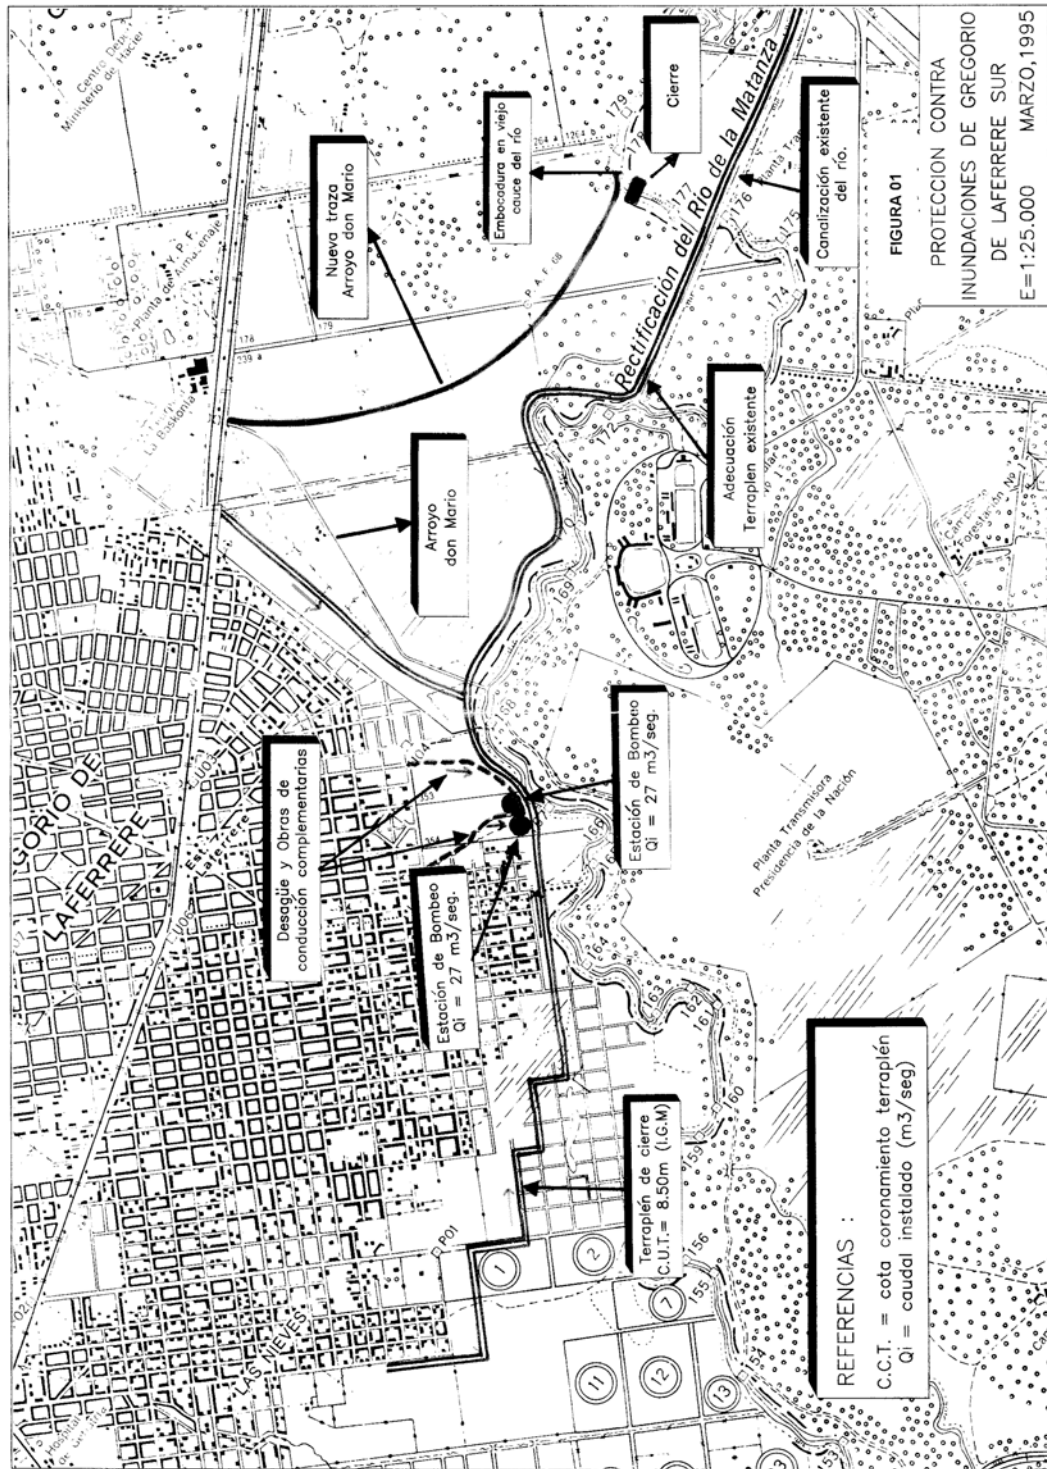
Protección contra inundaciones en la zona de Laferrere previsto según el Plan de 1994
